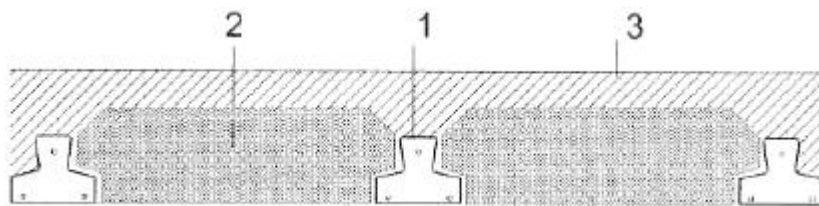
(1) viguetas prefabricadas. (2) ladrillos cerámicos. (3) capa de compresión.
